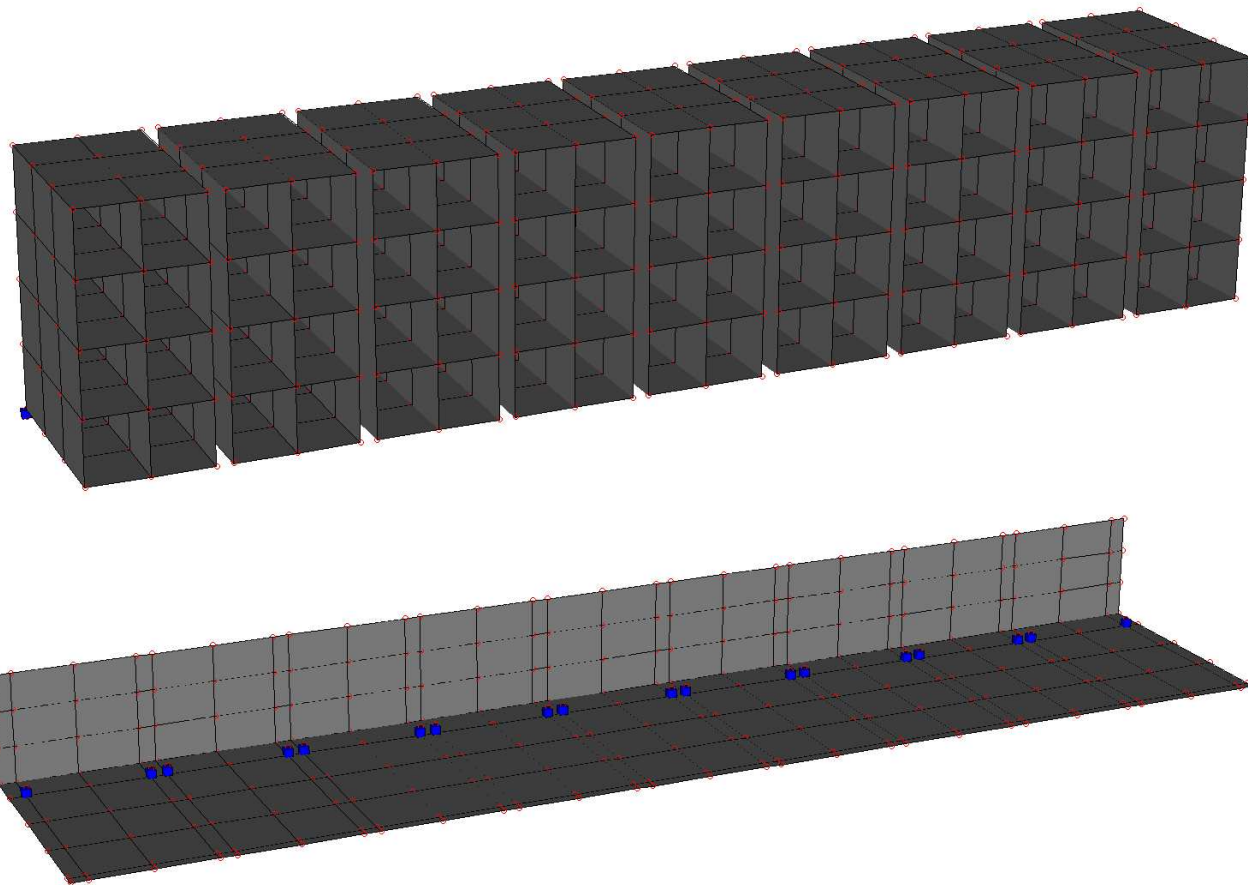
Vista tridimensionale degli elementi sottoposti a verifica
